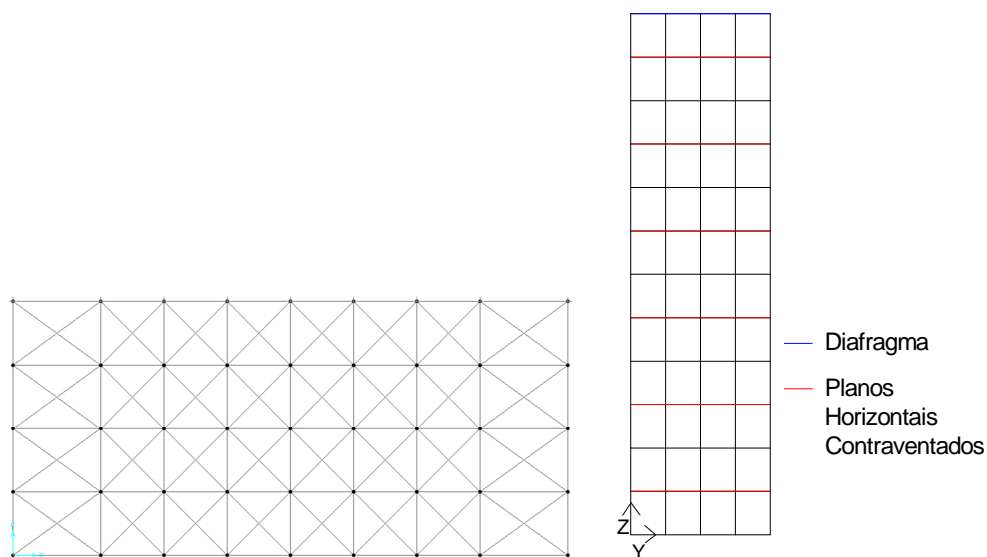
Configuração dos Planos de Contraventamento Horizontal Com Elementos de Contraventamento Pequenos
